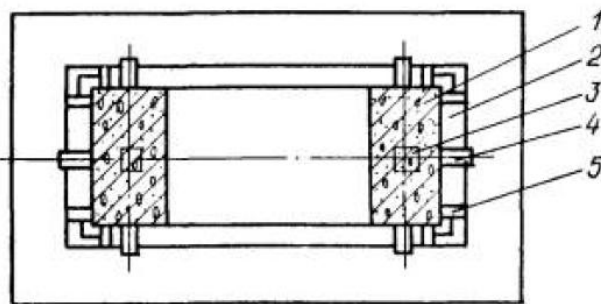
Временное закрепление колонн клиньями: 1 - колонны; 2 - стаканы фундаментов; 3 – армобетонные подкладки; 4 - клиновые вкладыши; 5 - инвентарные фиксаторы
